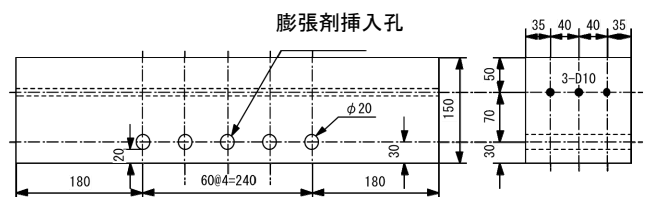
剥離ひび割れ誘発試験の供試体形状
